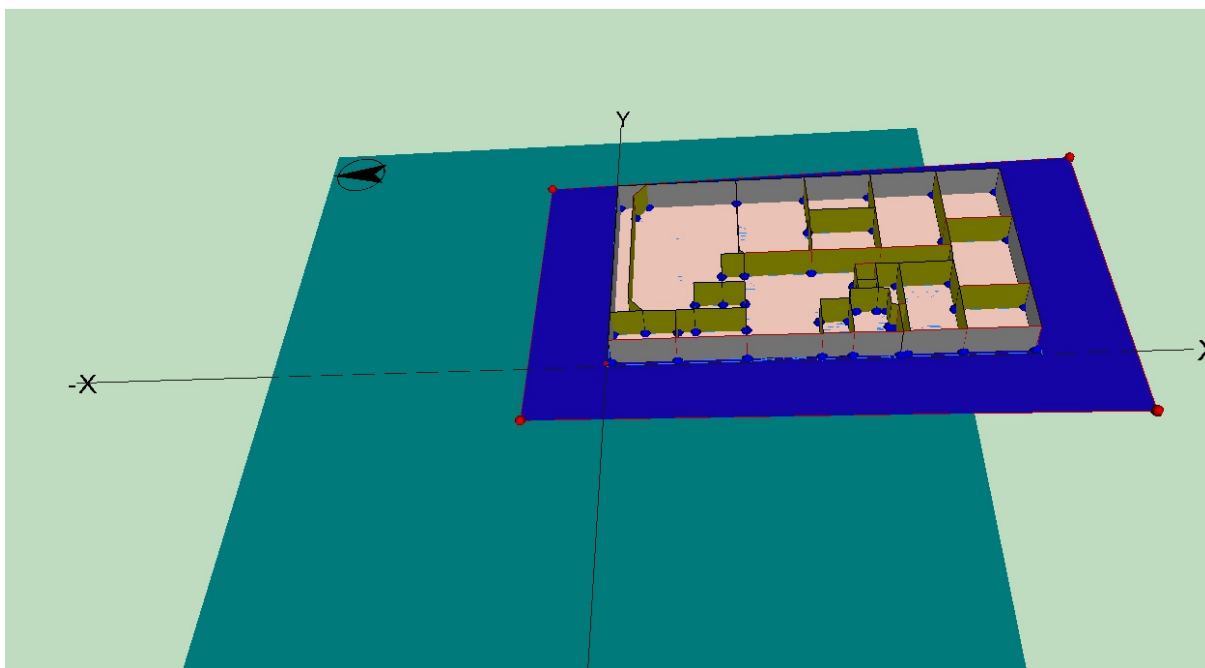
Cerramientos y particiones interiores en la planta baja
